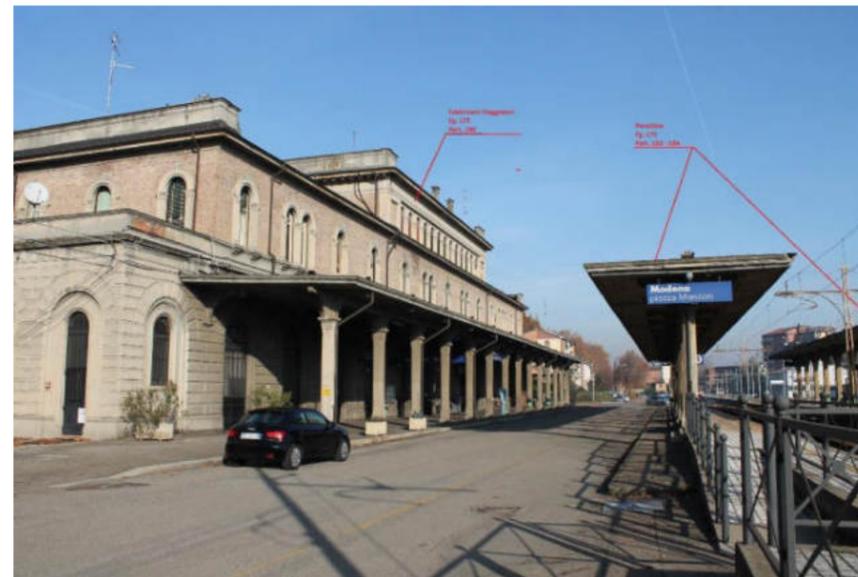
FV - Pensiline Stazione Modena Piazza Manzoni foglio 175, part. 190 – 193 – 194
